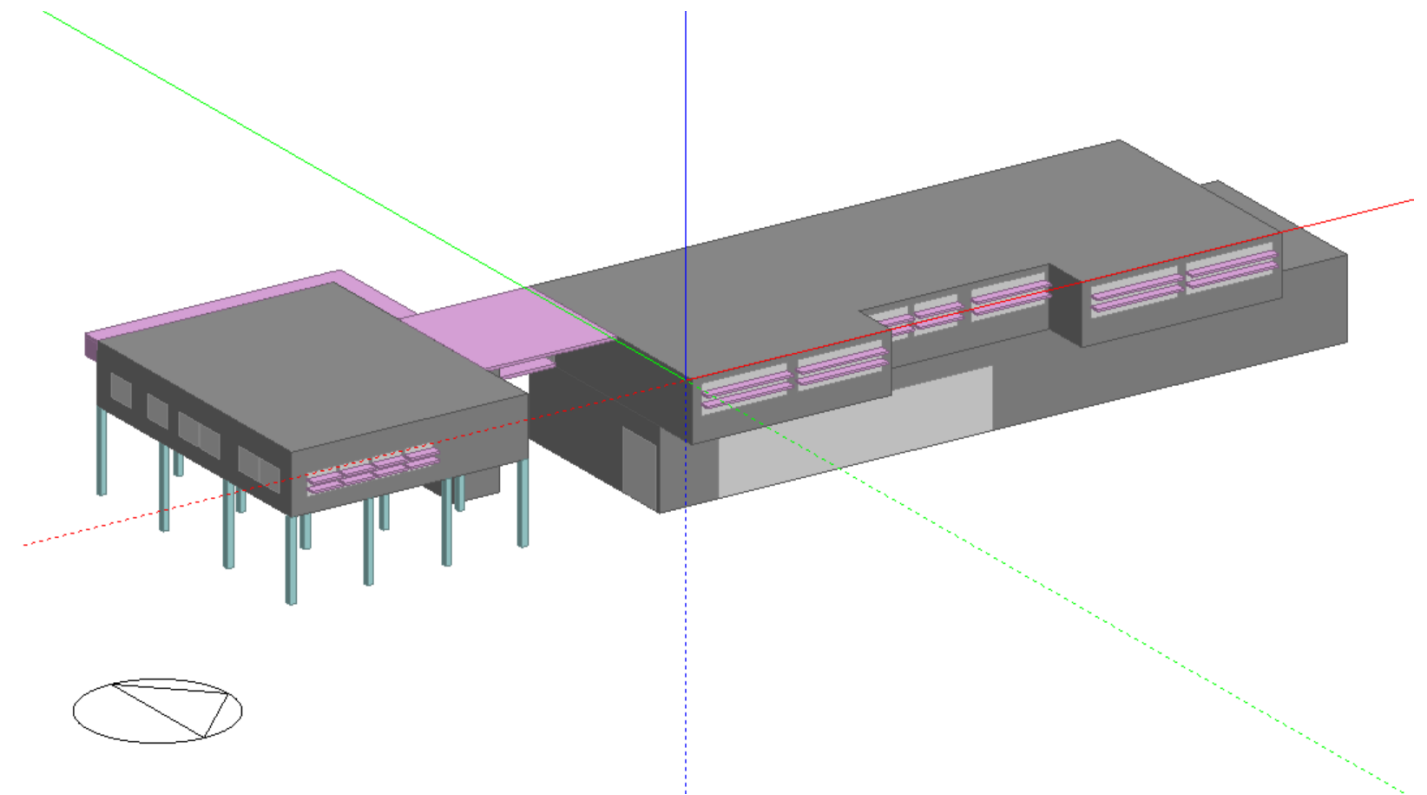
Perspectiva Sureste. Elaboración propia en Design Builder.
